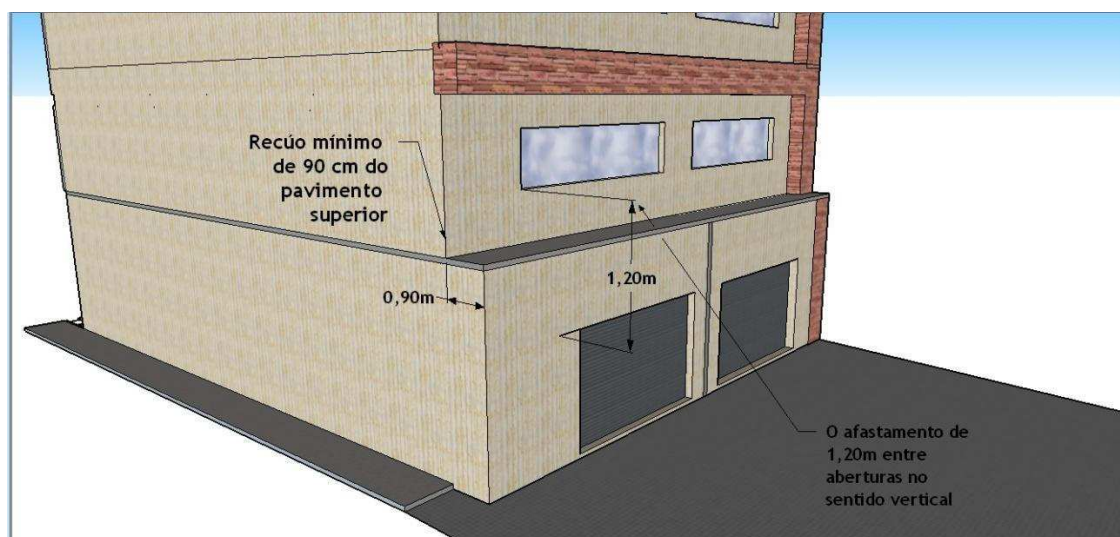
Recuo mínimo de 90 centímetros do pavimento superior
